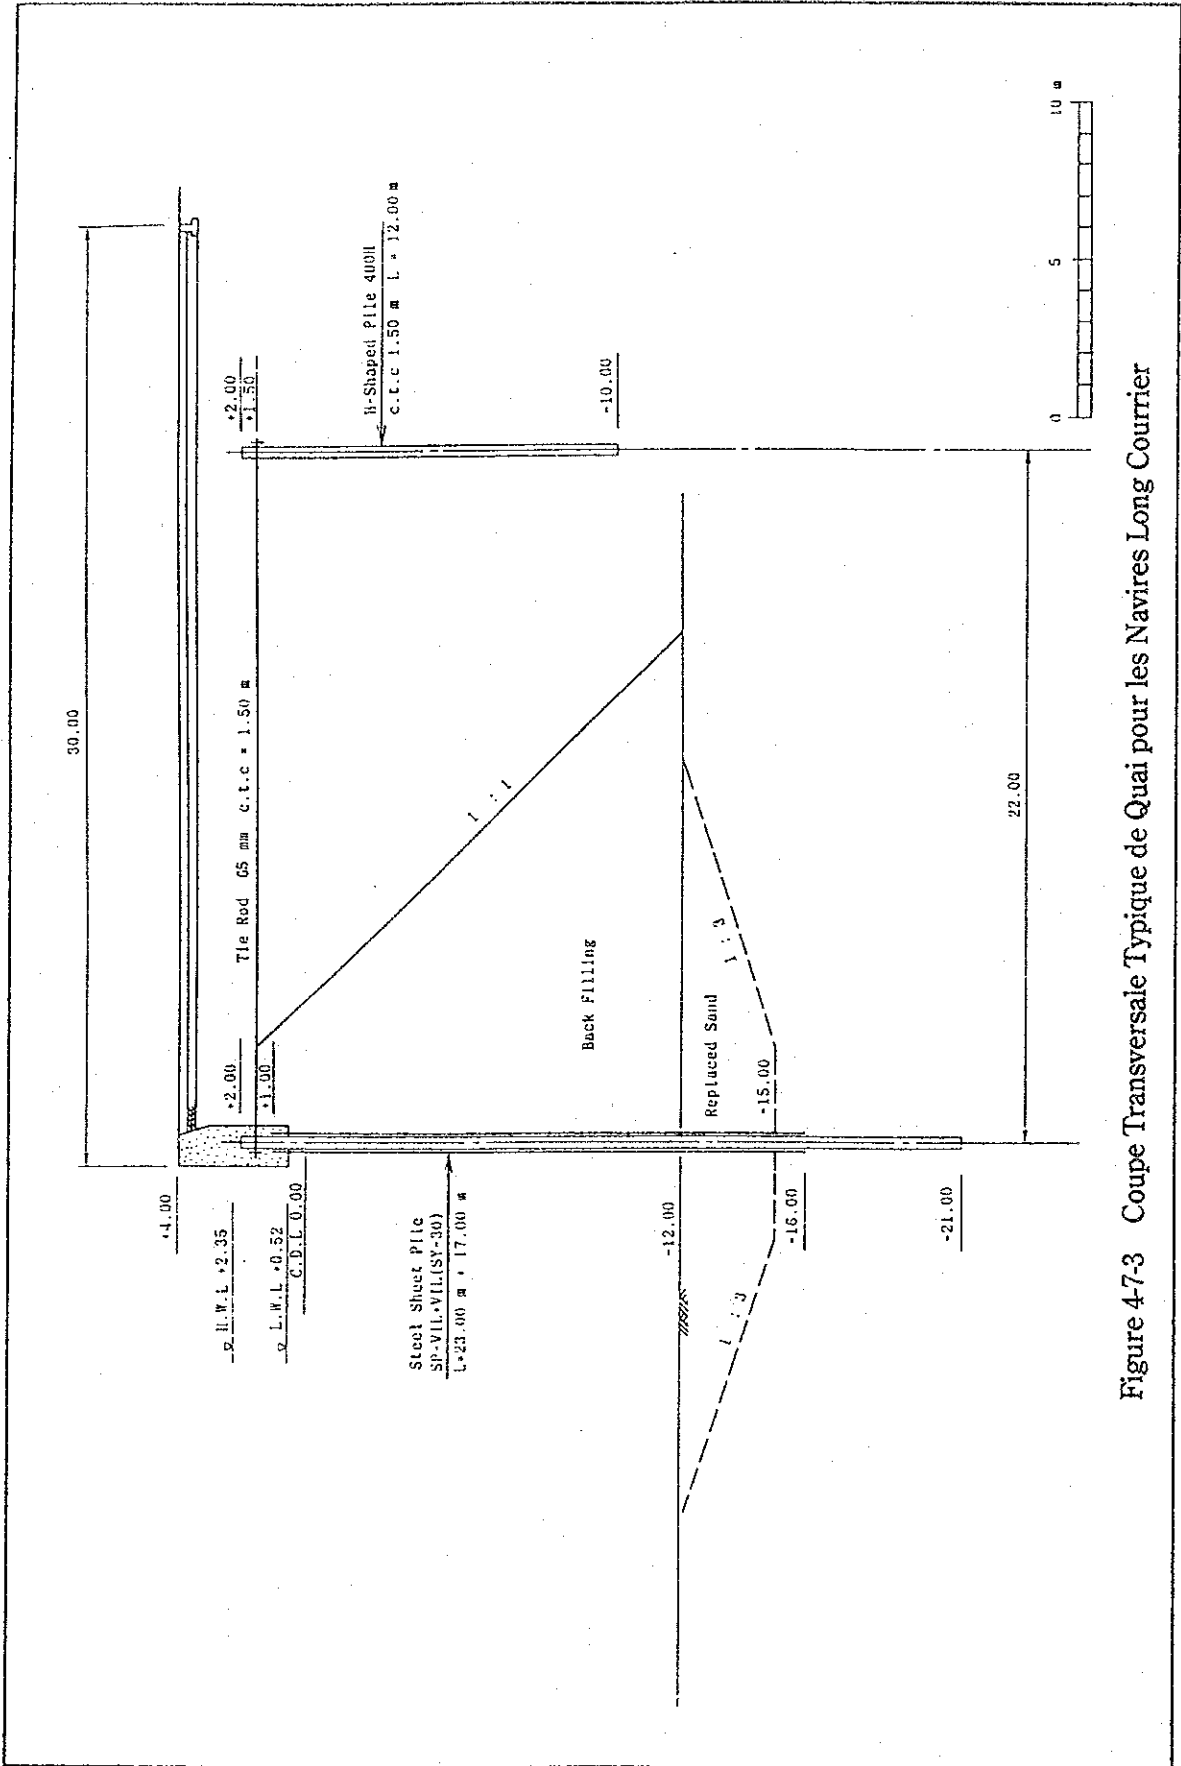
Coupe Transversale Typique de Quai pour les Navires Long Courrier
